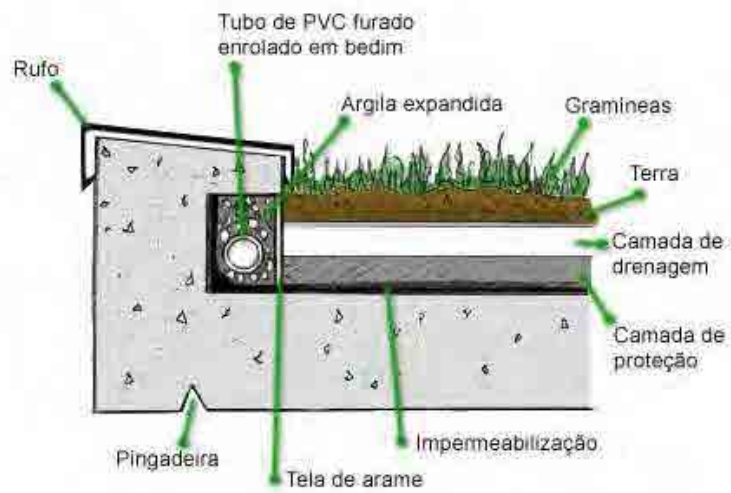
Detalhamento arquitetônico do sistema de cobertura verde plana.
